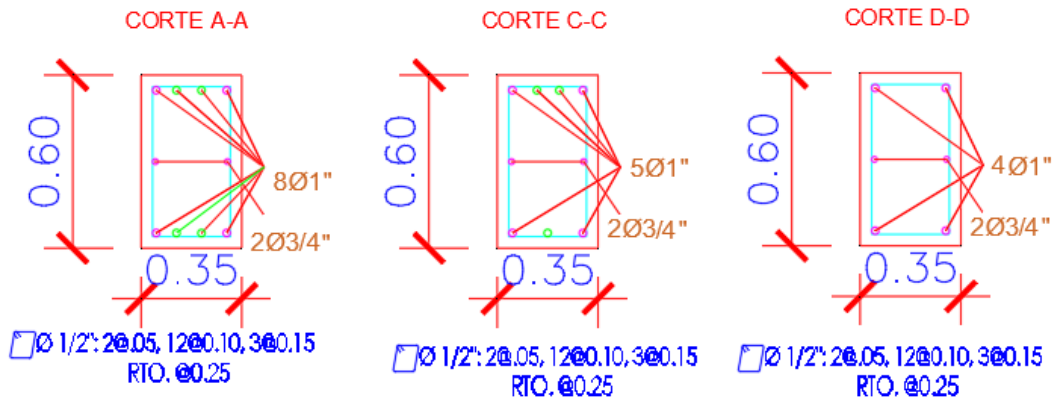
Secciones de Viga con Refuerzo 3° Piso
